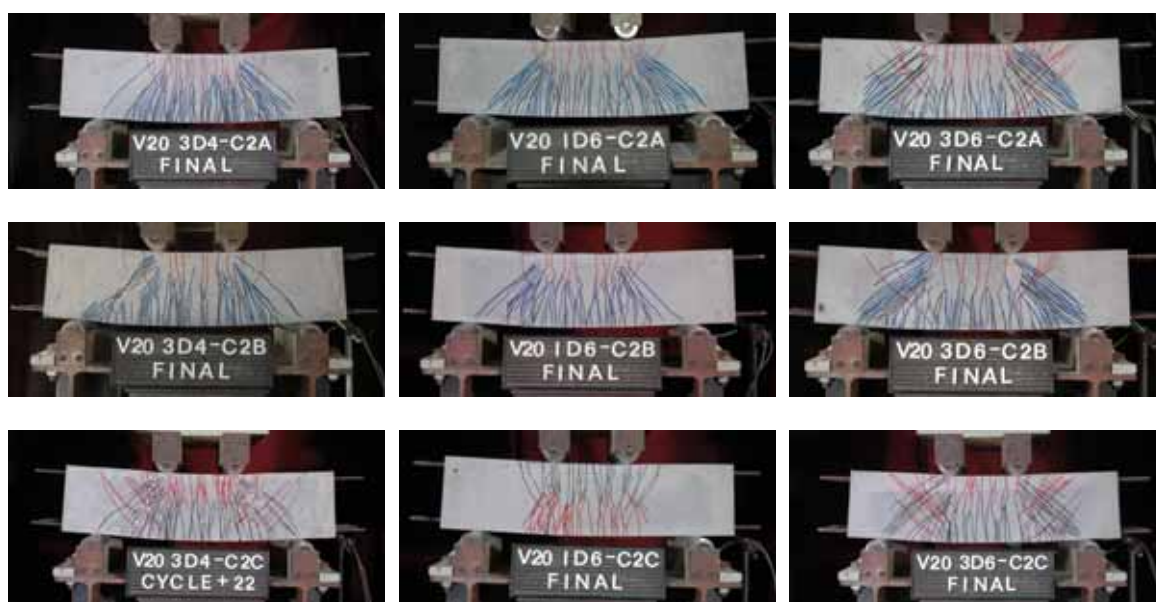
繰返し載荷試験体 最終ひび割れ状況
